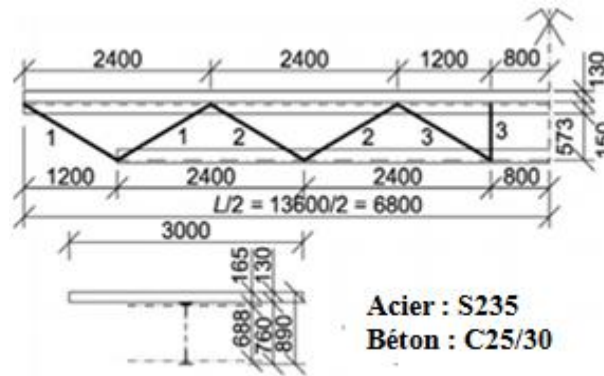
Ferme mixte acier et dalle en béton [90]
